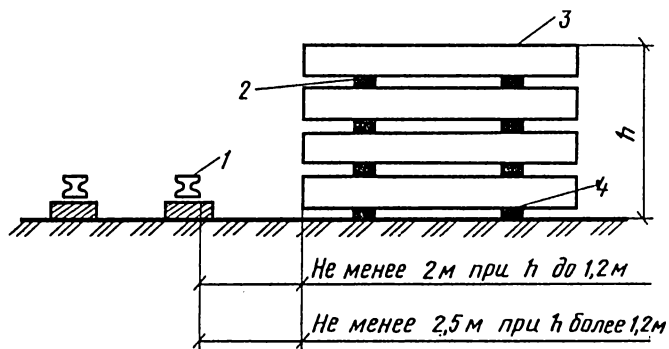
Схема размещения штабелей грузов у железнодорожного или кранового пути
